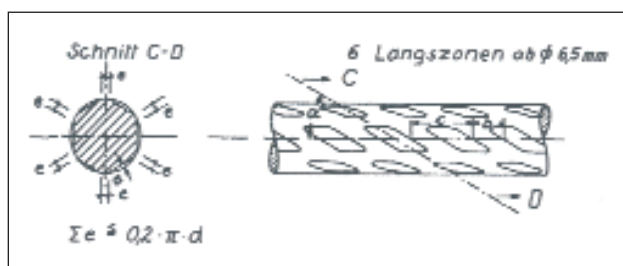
Betonstahlmatten mit Sonderprofilierung ab 1968 mit sechs Rippenreihen, aus [26]
